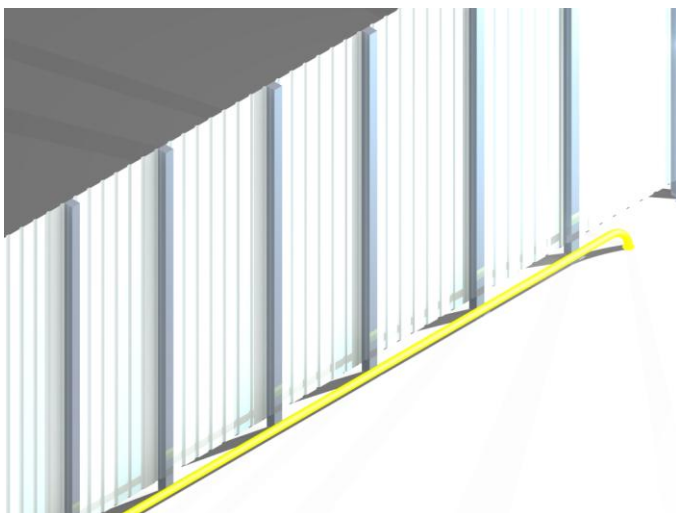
Divisória vista pelo lado do armazém com protecção para empilhadores.
